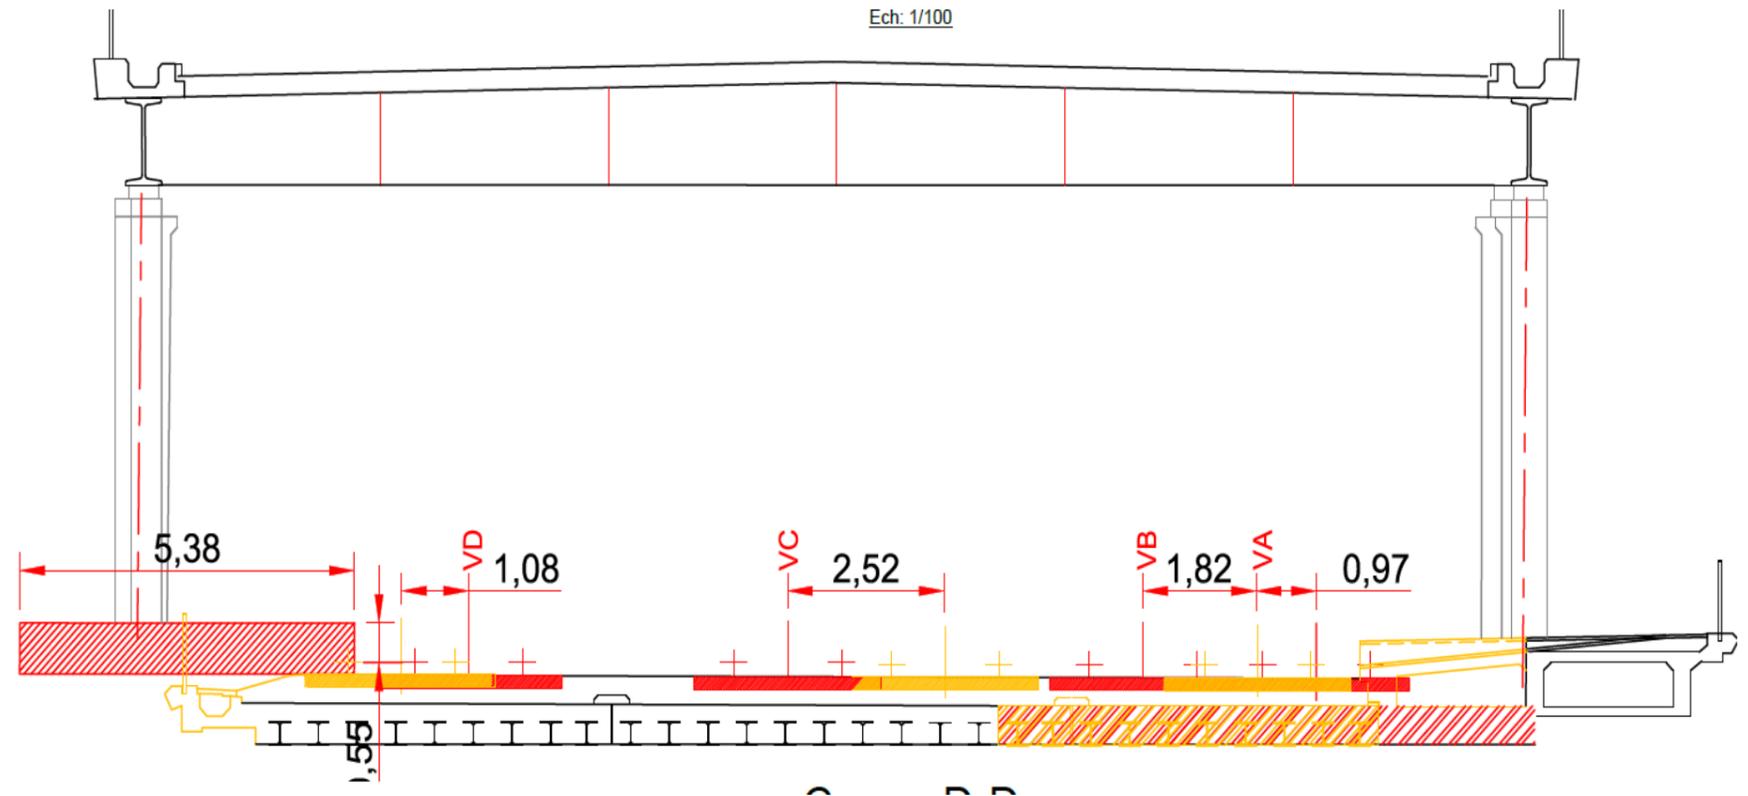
Coupe sur le pont-rail du ruisseau de la Foux (Systra, 2021)
